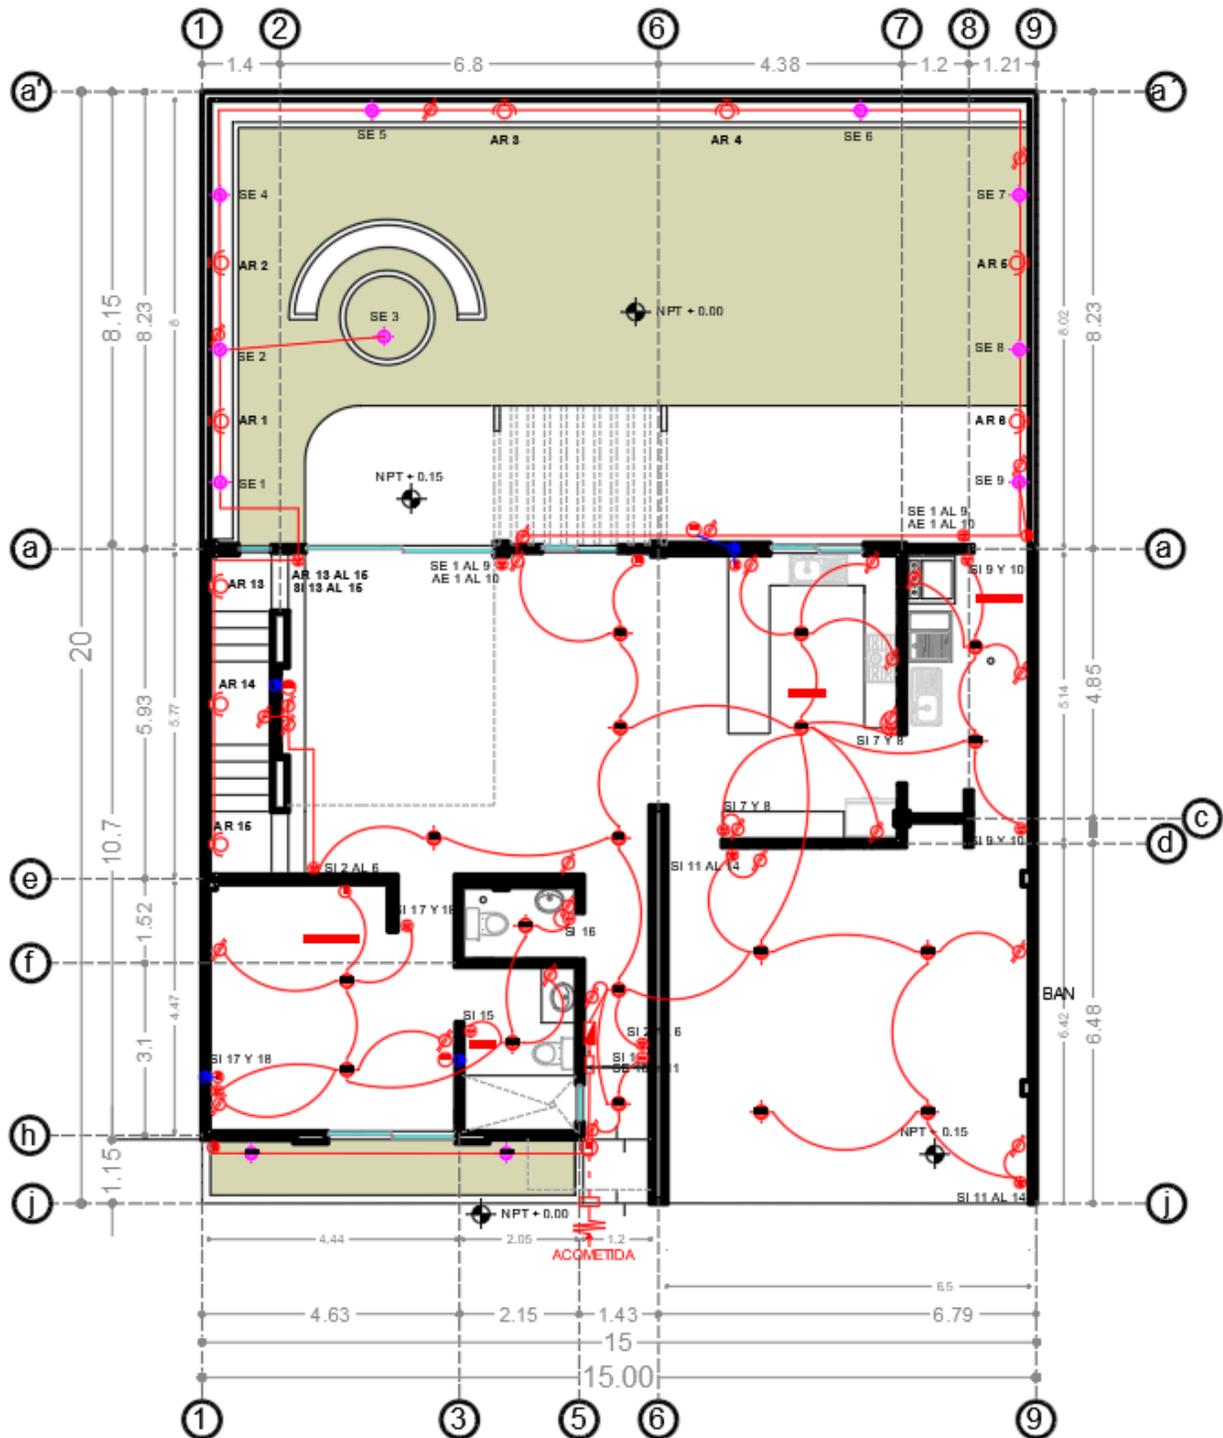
Plano eléctrico planta baja (Muciño, 2022)
